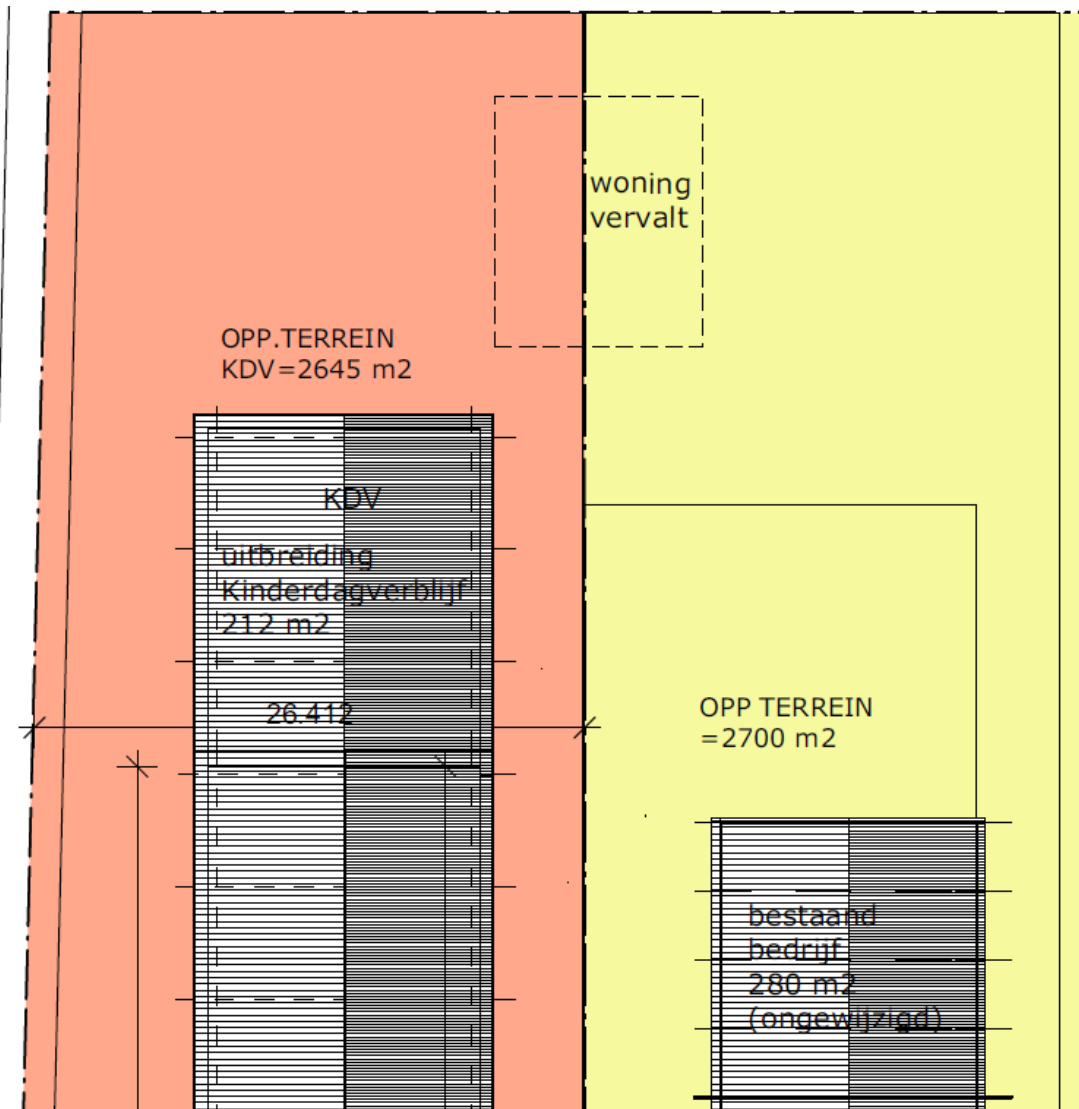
Situering uitbreiding ten opzicht van bestaand bedrijf
